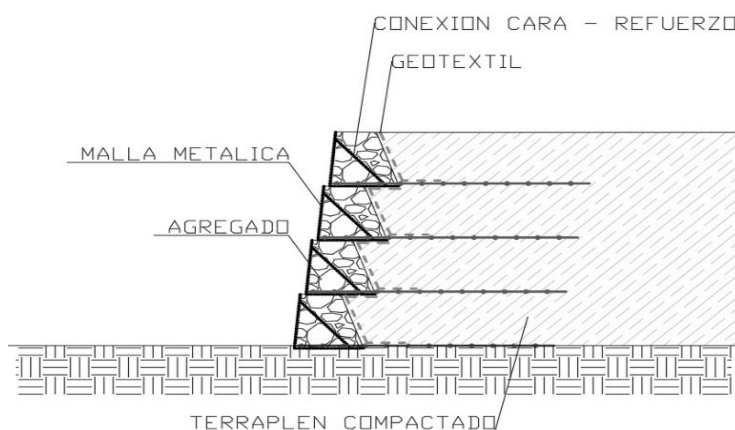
Sistema muro reforzado con paramento frontal de malla metálica soldada
